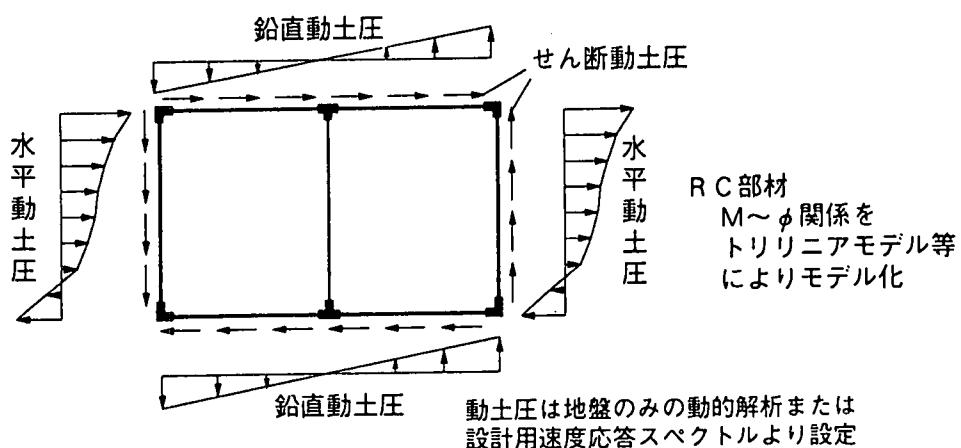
地中構造物横断面の動的解析法のモデル化と地震荷重⁴¹⁾
